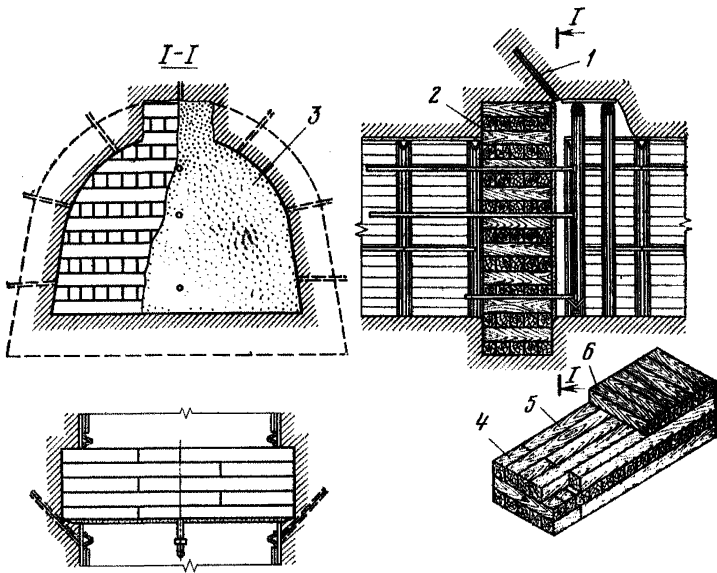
Брусчатая динамически устойчивая перемычка
